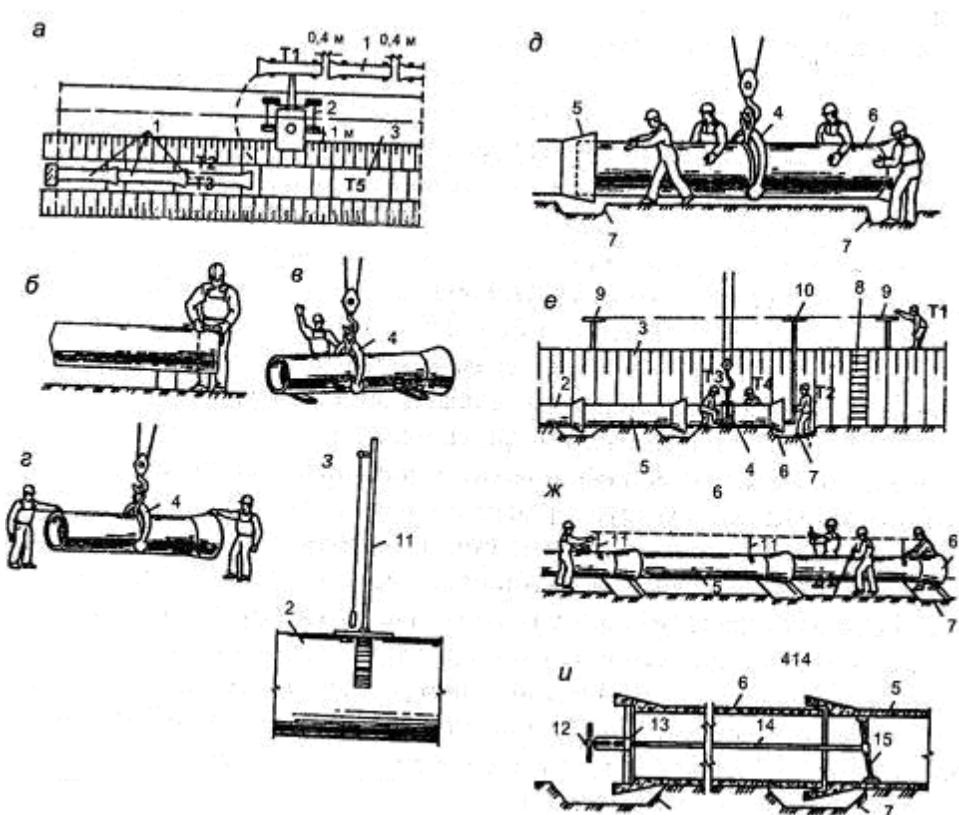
Основные рабочие операции при монтаже трубопровода из железобетонных расструбных труб: а – общая схема организации работ (Т-1, Т-2, Т-3, Т-4, Т-5 – рабочие места трубоукладчиков); б – разметка гладкого (втулочного) конца трубы шаблоном; в, г – строповка трубы и опускание ее в траншею с помощью клемцевого захвата; д – введение гладкого конца трубы в расструб; е – выверка положения трубы в плане по вешкам; ж – центрирование трубы; з – инвентарная вешка с отвесом; и – натяжное устройство; 1 – трубы; 2 – кран; 3 – траншея; 4
